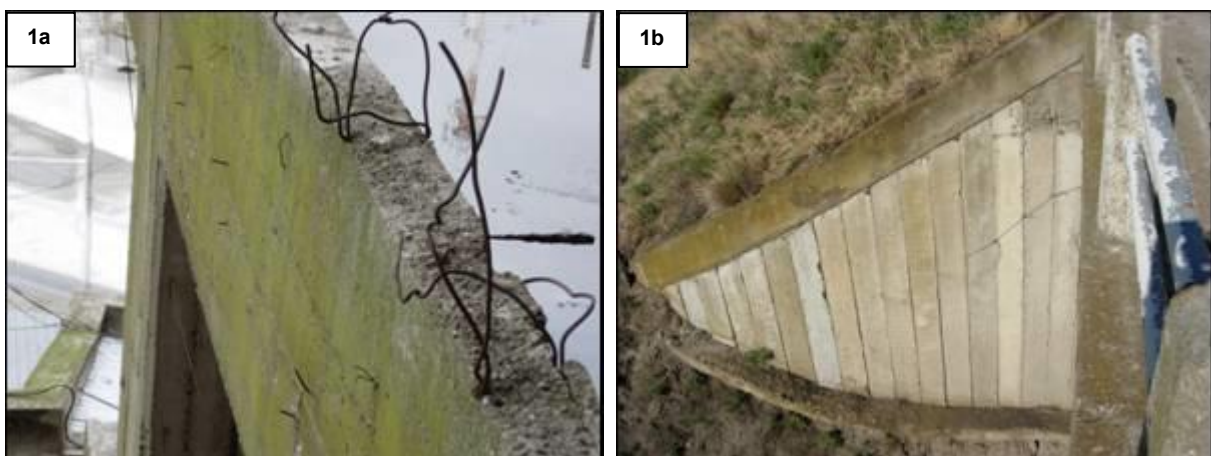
Hormigón en ambiente urbano. 1b.: Hormigón en ambiente rural
